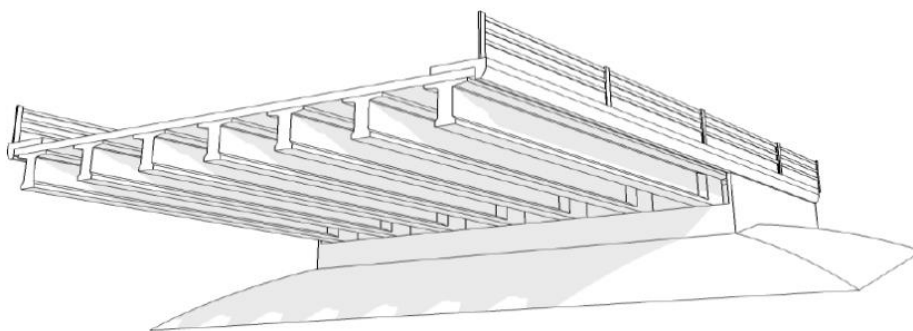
Morphologie générale d'un pont à poutres multiples en béton précontraint
